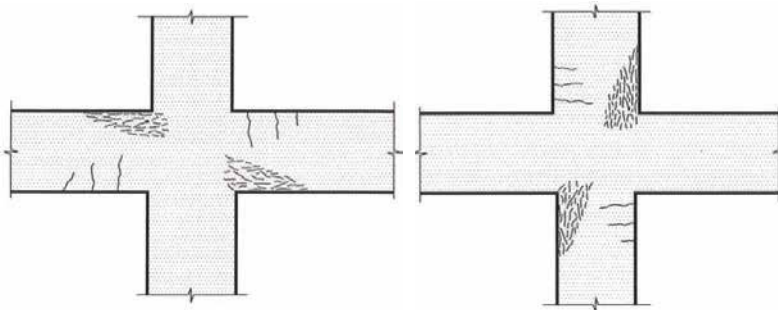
Fisuras en zonas de nudos (Fuente: Calavera, 2005)
